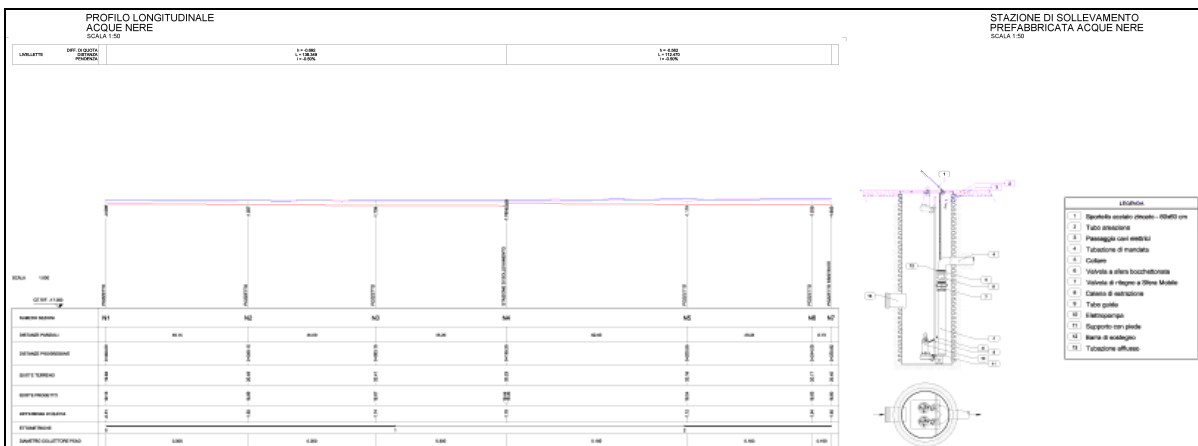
Profilo acque nere e stazione di sollevamento prefabbricata
